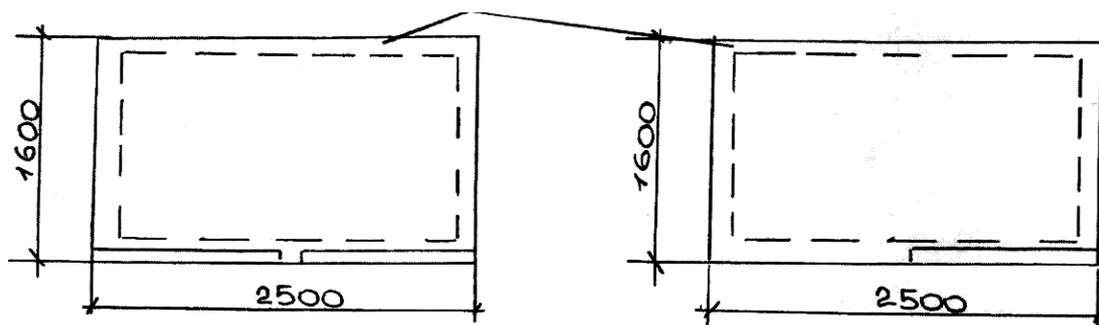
Площадки лестничные железобетонные 2ЛП 25.15-4 для жилых зданий с высотой этажа 3,0м
